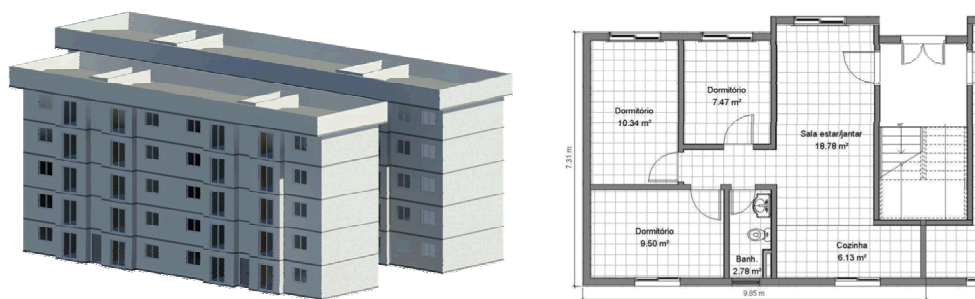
Edificação A: Fachada e planta baixa parcial do andar tipo
